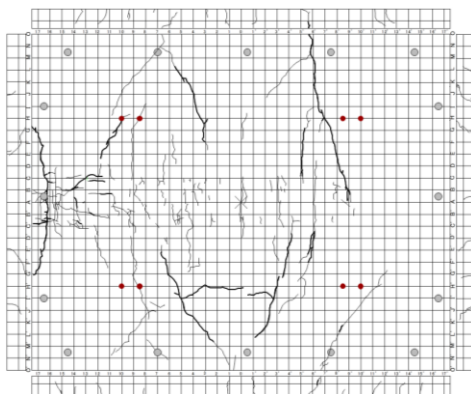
に床版上面のひび割れ状況を示す。また、図-3.6(d)にて、四角の表示範囲は押抜きせん断破壊時の破壊位置の上面部を示している。事前走行終了時では、橋軸直角方向のひび割れが床版の右側に発生している。鋼板接着補強後、荷重 160kN で走行した 30 万回走行後では、走行位置上に長さの短いひび割れが多数発生している。その後、荷重が 180kN に増加した後、45.2 万回走行終了時では、事前走行終了時までに発生した橋軸直角方向のひび割れの進行およびひび割れ幅の拡大と、床版左側の走行位置上にひび割れの進行が確認できる。樹脂の再注入後から破壊に至る 61 万 7169 回走行終了時では、全体のひび割れがスリット化し、破壊位置の上面コンクリートは土砂化していた。
